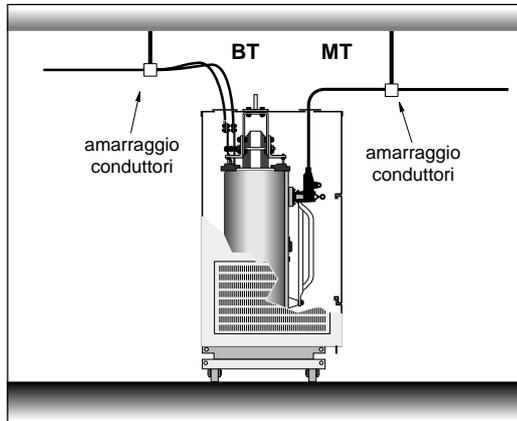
collegamenti MT e BT provenienti dall'alto.
